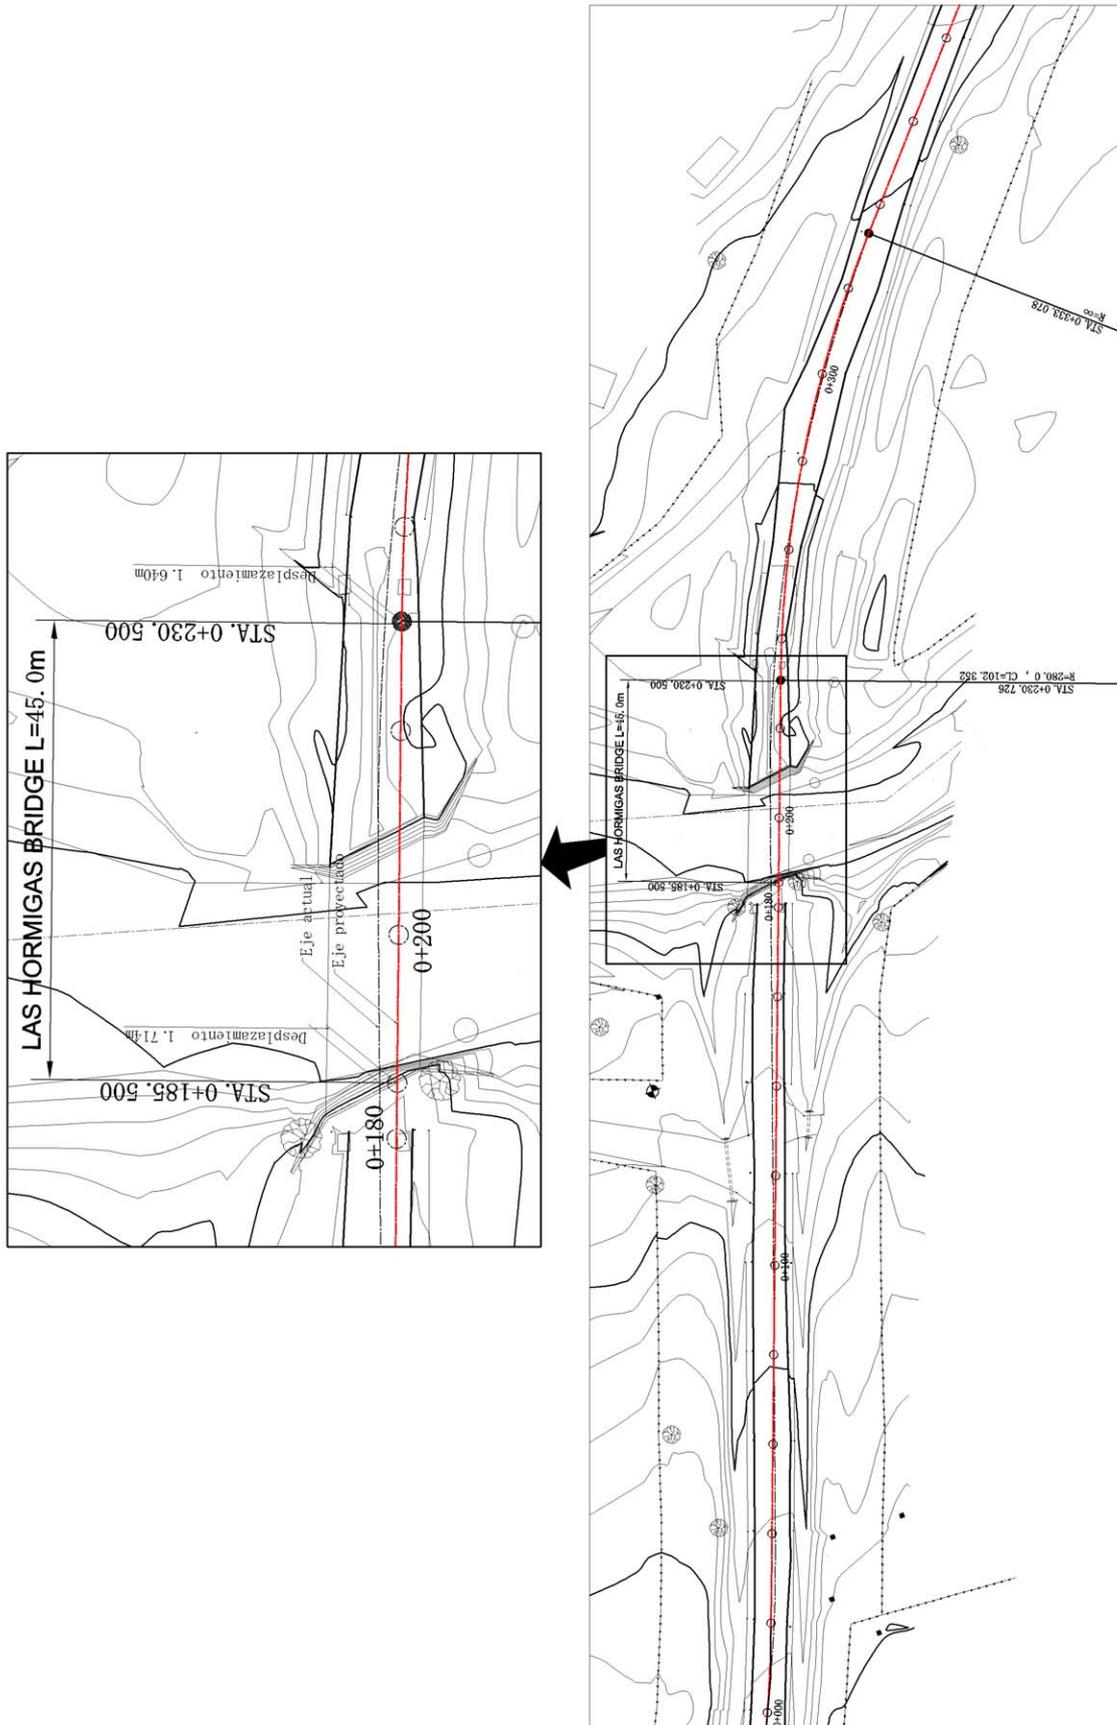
Alineamiento Horizontal de la Carretera de Aproximación del Puente Las Hormigas
